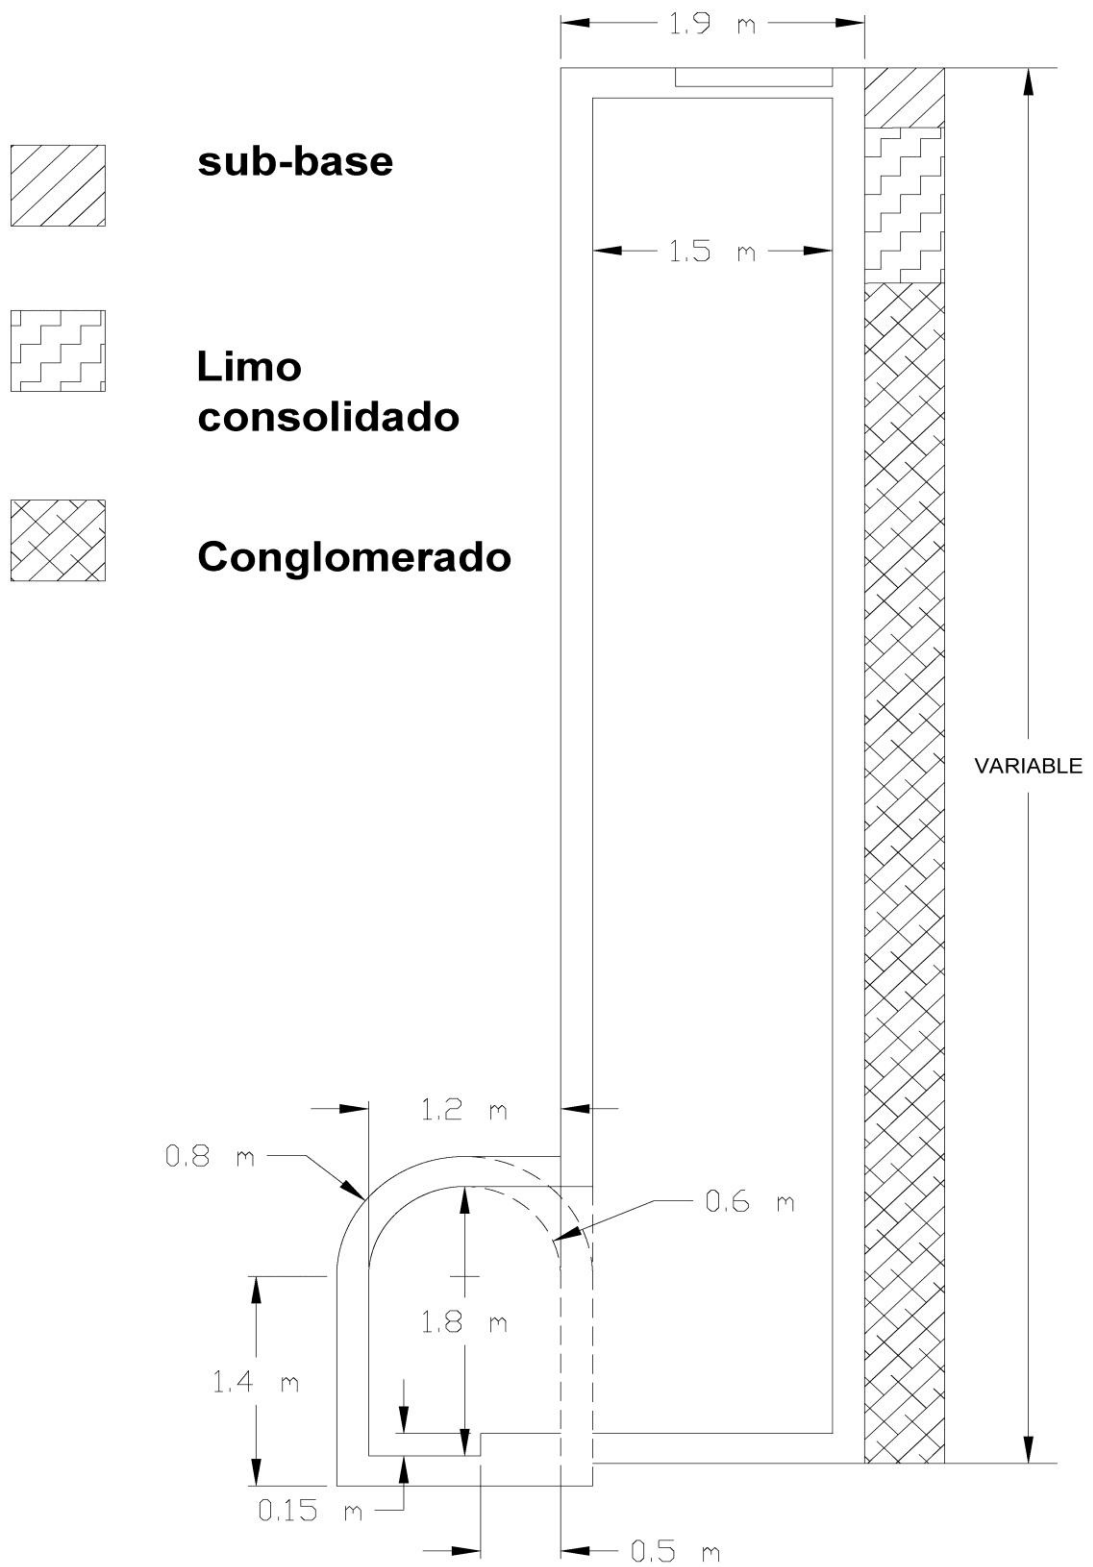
Detalle de pozos de visita y de la sección del túnel.
